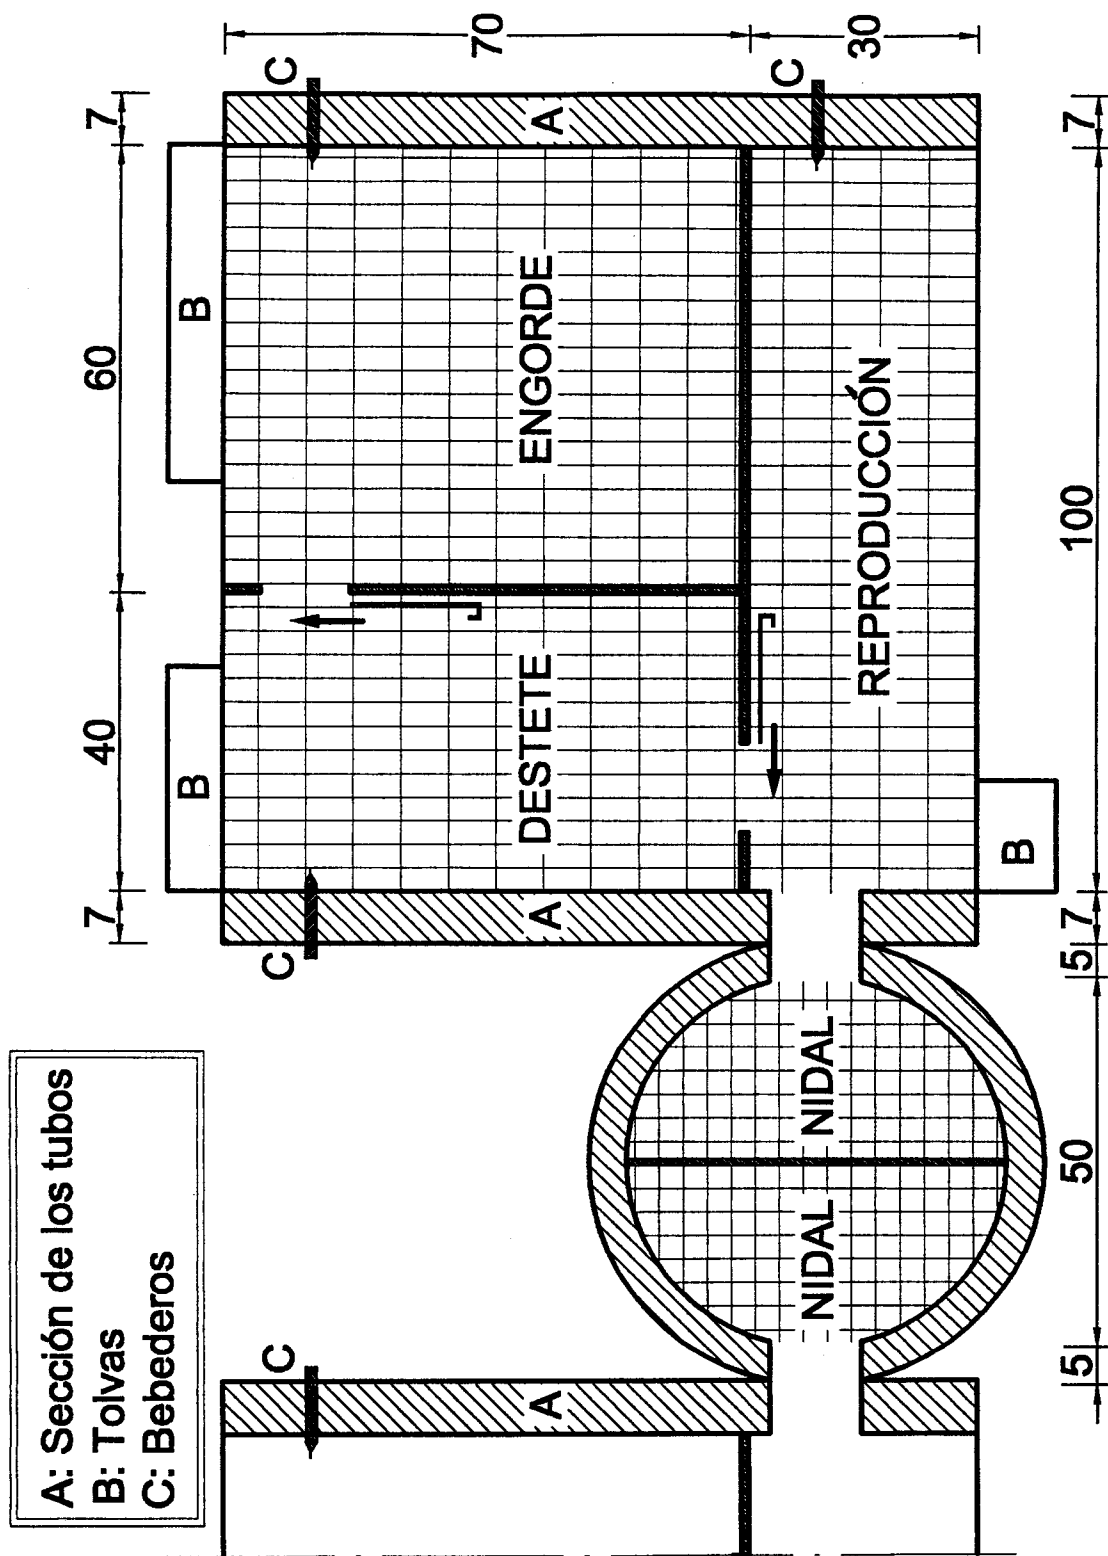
Planta de la estructura de un sistema de reproducción y engorde en tubo de cemento prefabricado
